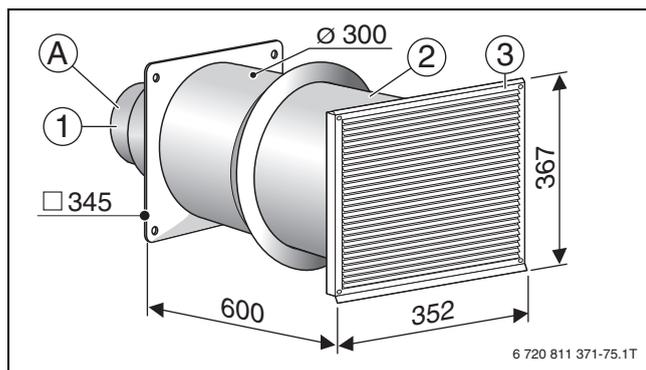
Dimensioni della bocchetta a parete WG 160-2 (quote in mm)
